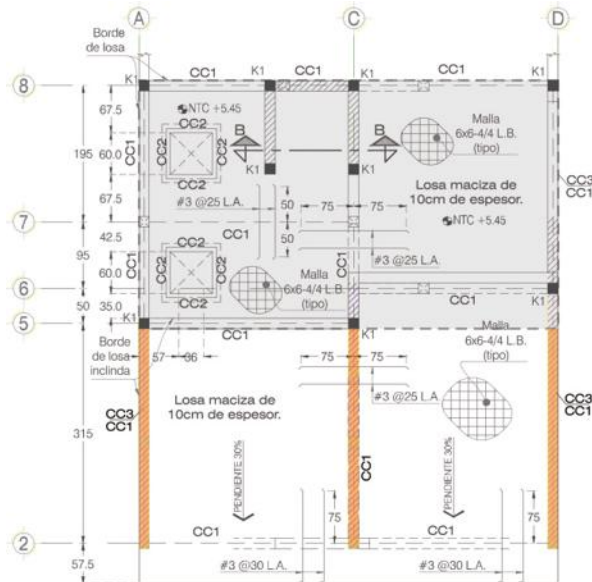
DETALLE EN PLANTA DE Cc1 PARA LOS MUROS A, C Y D
